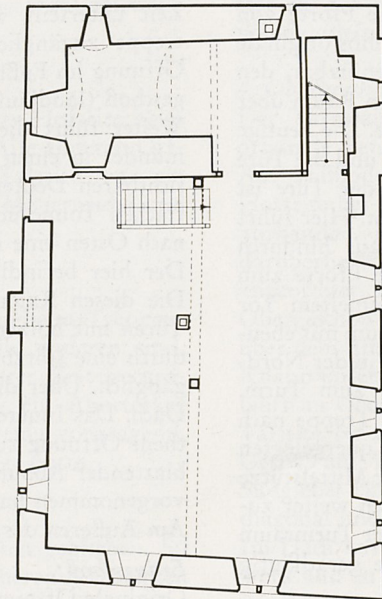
Grundriß vom 3. Obergeschoß M 1:200, Zustand 1971
